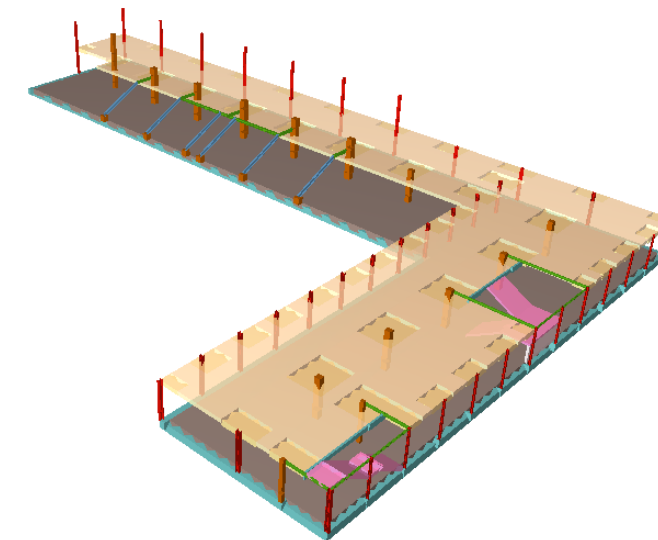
Fase 2 – Ejecución de la primera planta de forjado y graderío inferior. Fuente: Propia.
